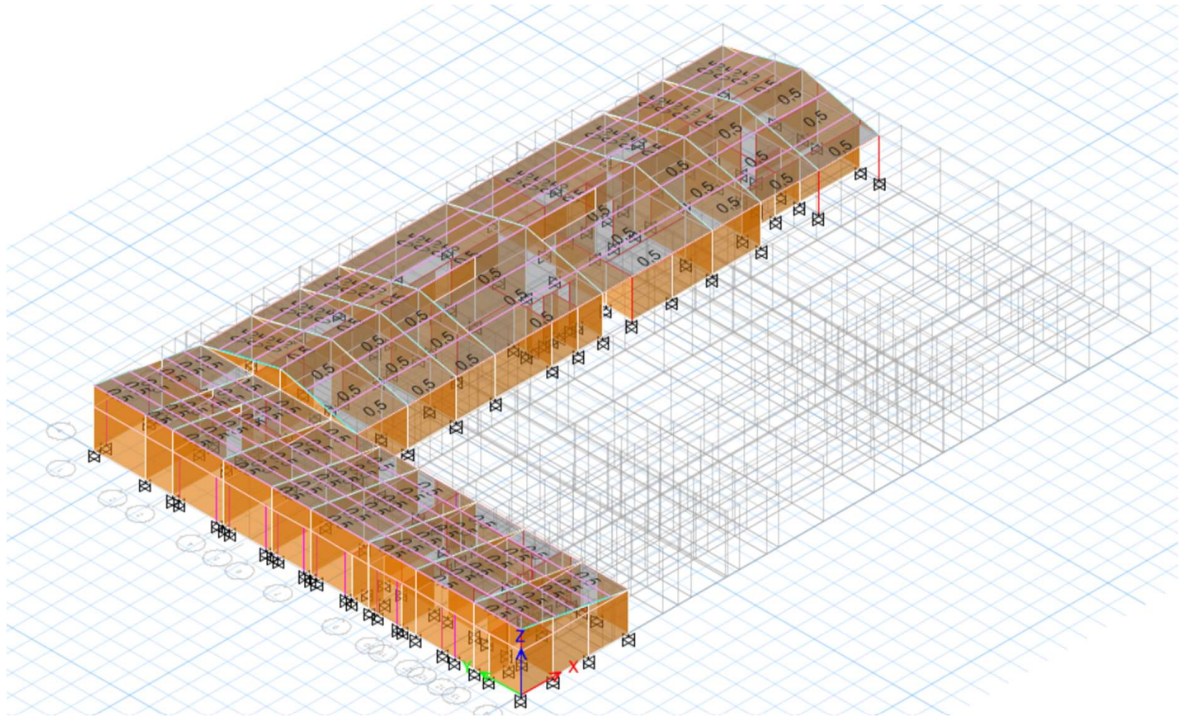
Carga muerta para las losas 2,5 kN/m<sup>2</sup>
